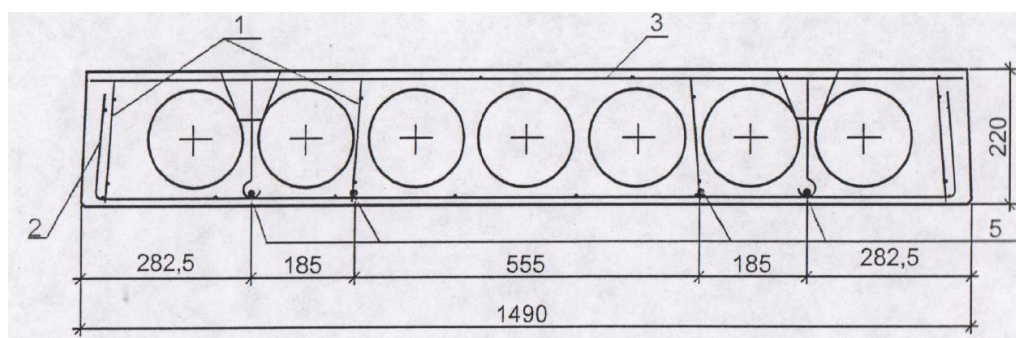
Плита перекрытия железобетонная многопустотная: 1 - каркас Кр1; 2 - сетка С2; 3 - сетка С56.15; 5 - стержни напр. $\varnothing 12\text{AtV}$
